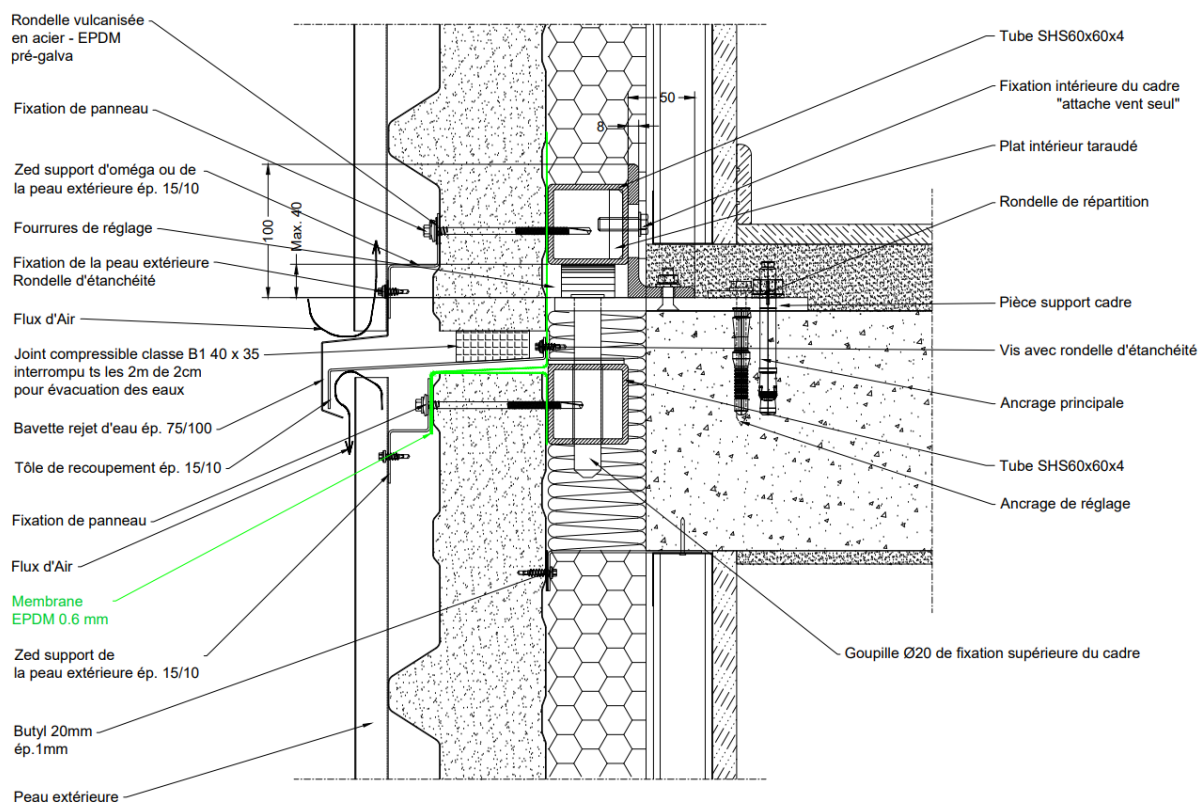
Coupe verticale sur la jonction horizontale entre modules D2B Archisol – Ancrage intermédiaire (vent seul) - Pose directe.
